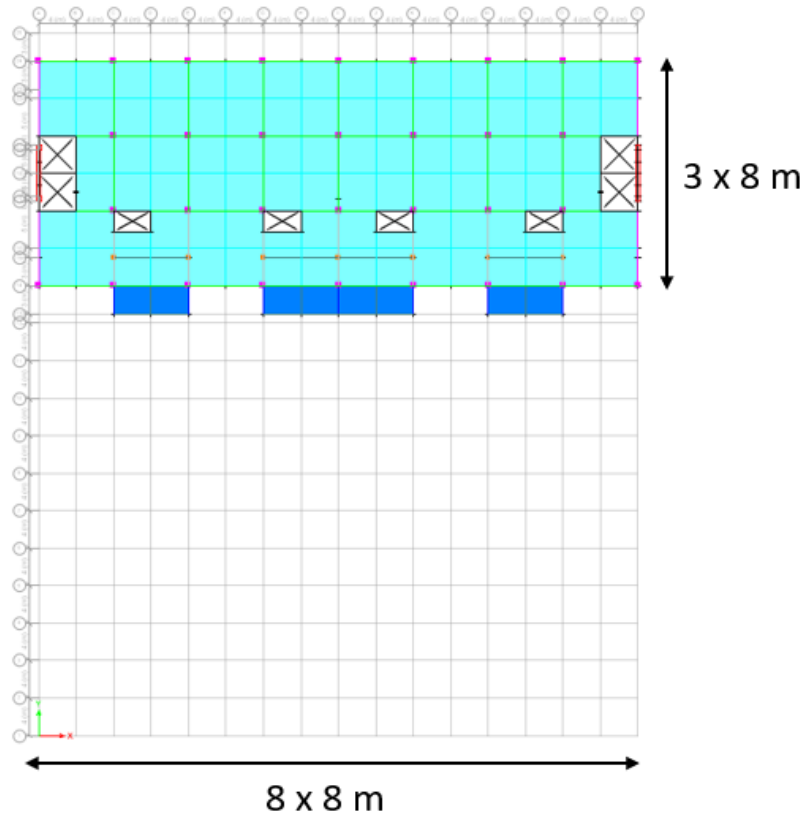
Denah Tipikal Lantai 7 dan 9 Untuk Model 2
